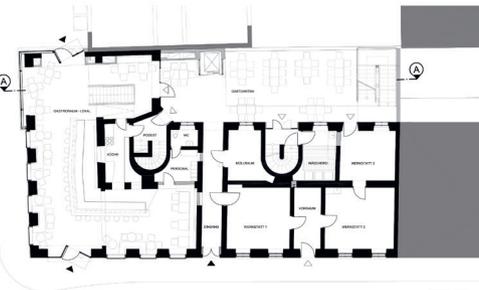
| VinziRast. Grundriss Erdgeschoß
